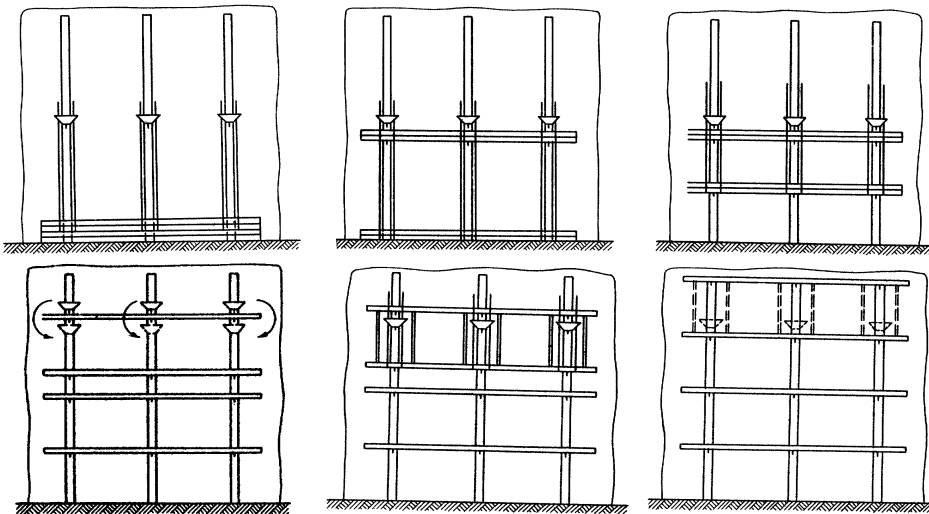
Схемы возведения сооружения (здания) методом подъема перекрытий и покрытия
